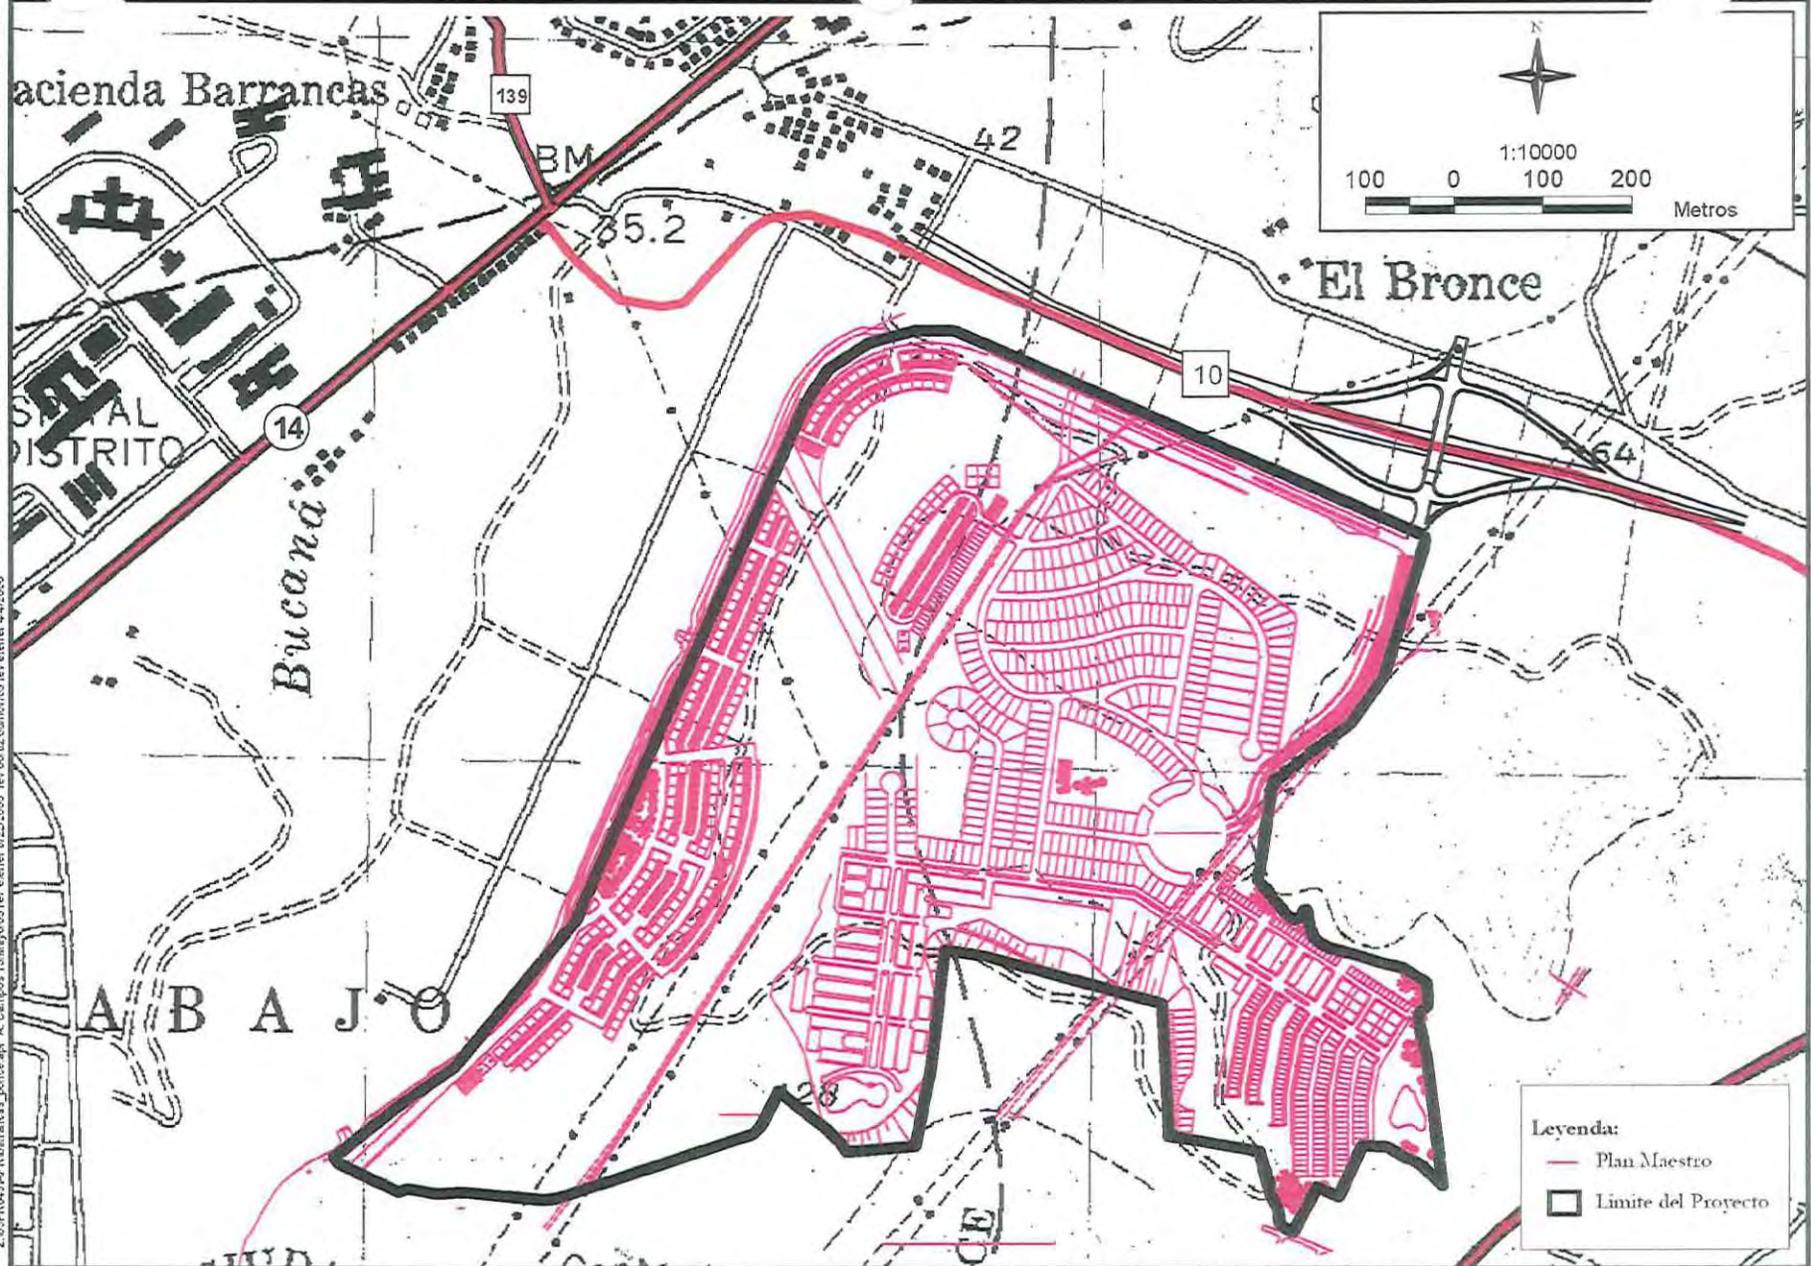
Plano Esquemático Original del Proyecto Propuesto
